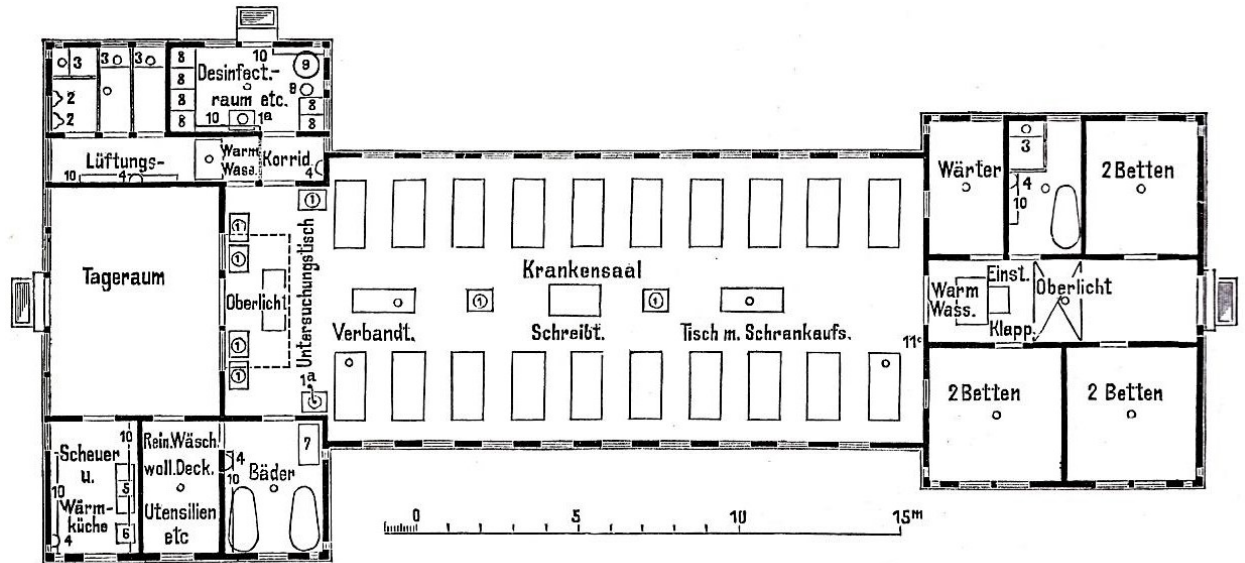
Grundriss einer typischen Krankenbaracke (1896), Krankenhaus Moabit
